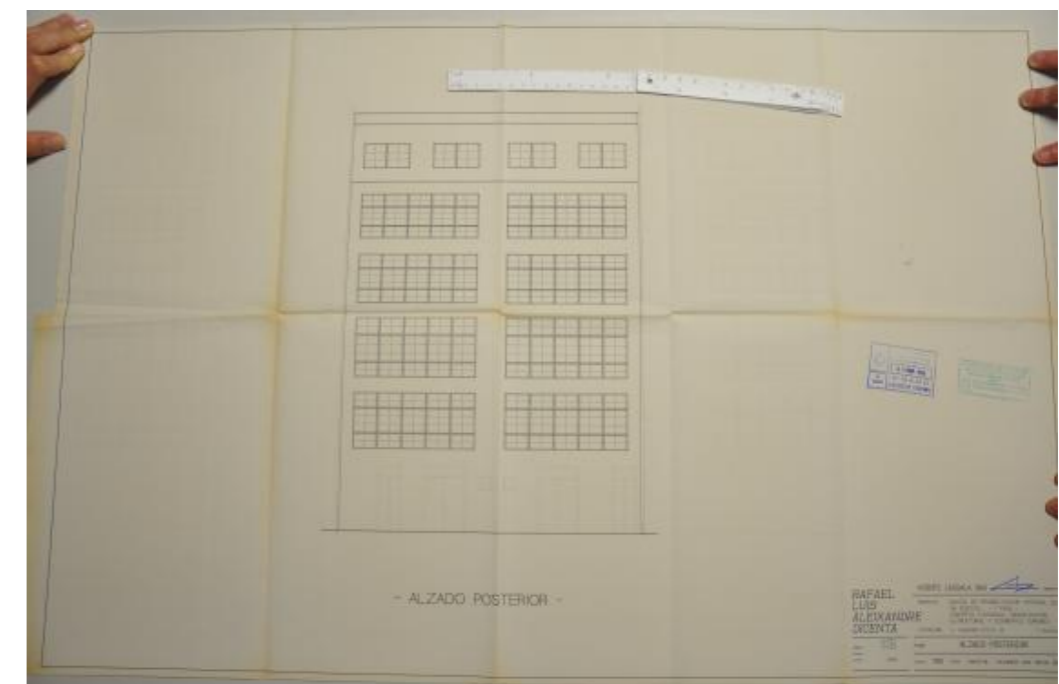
Plano de alzado donde se muestra el estilo de ventanal utilizado
